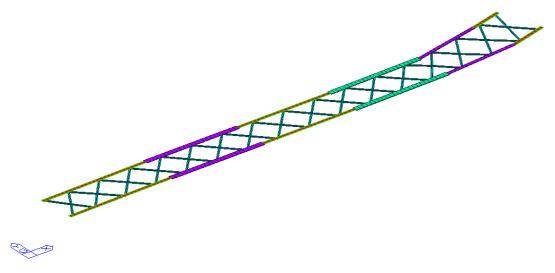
Vista del sistema di controventamento superiore – Rampa C
